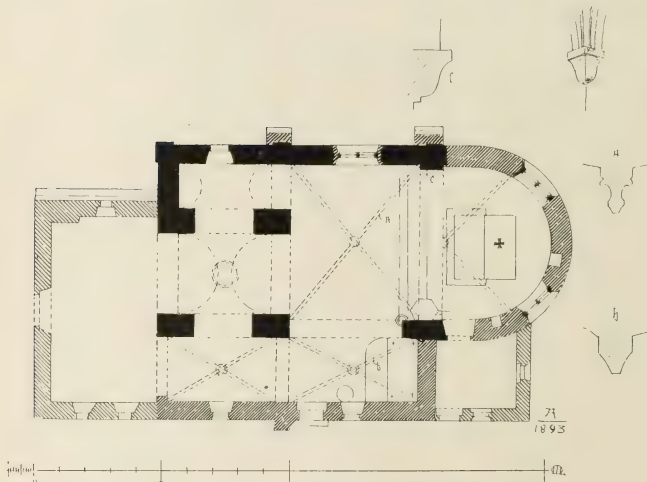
Rodenkirchen. Grundriss der ehemaligen Pfarrkirche.
